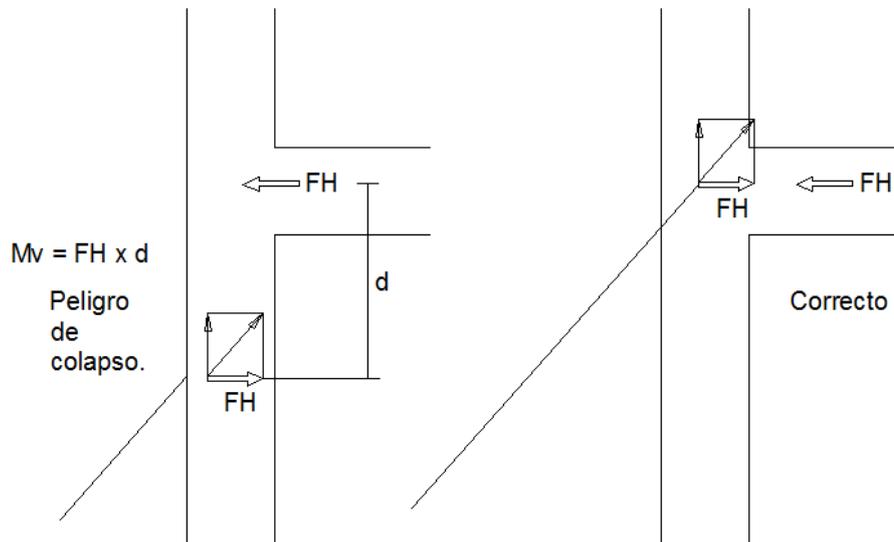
Evitar hacer trabajar a flexión un muro de fachada apuntalado con tornapunta.
